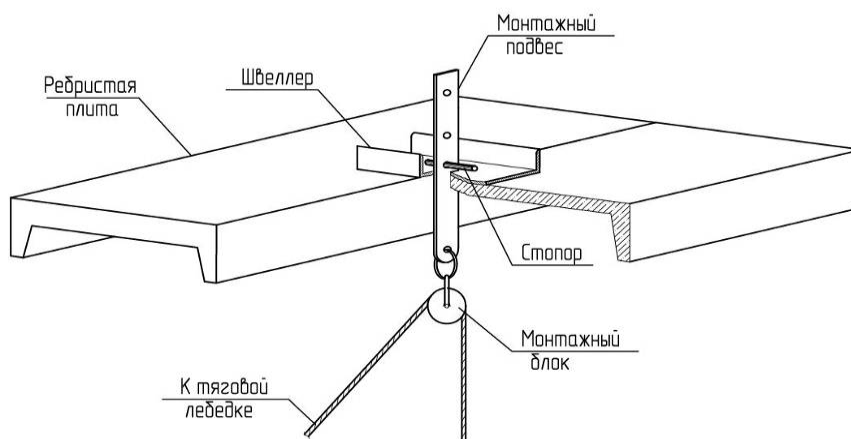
Вариант крепления монтажной оснастки для ребристой плиты
